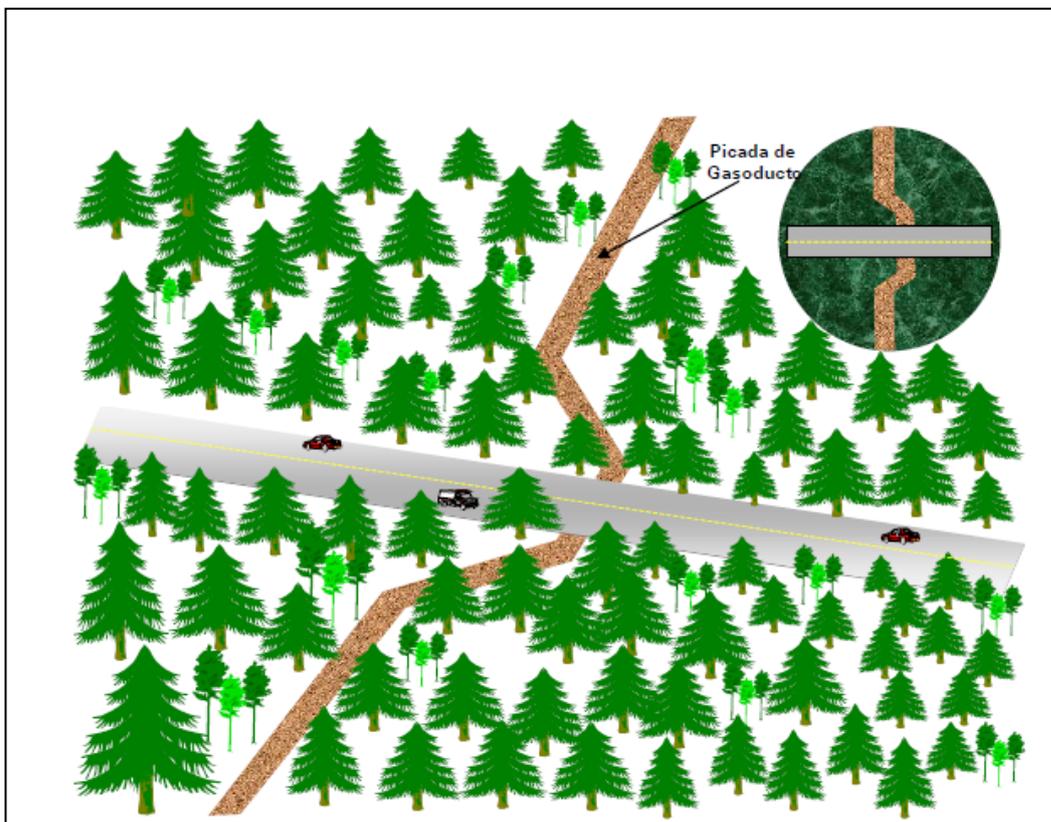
Desvío de pista para reducir el impacto paisajístico durante la apertura de pistas.
